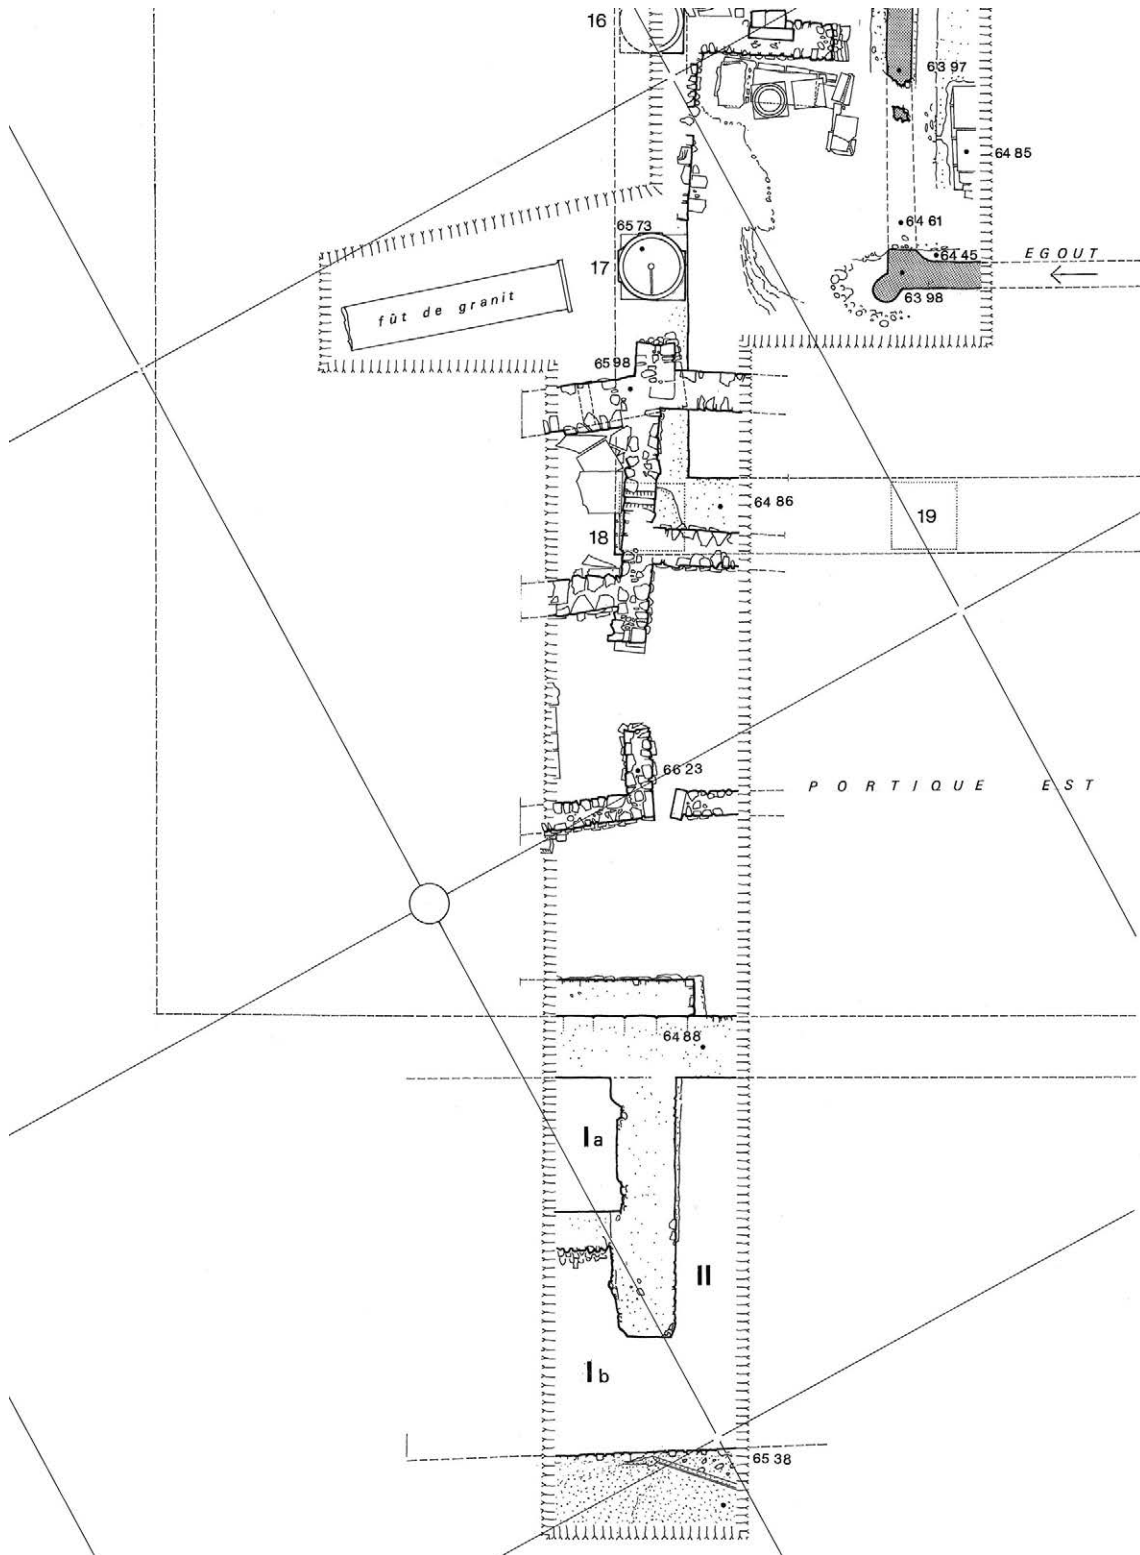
Plan de détail de la colonnade méridionale (colonnes 16 à 19, traversée du portique est et salles I-II)
